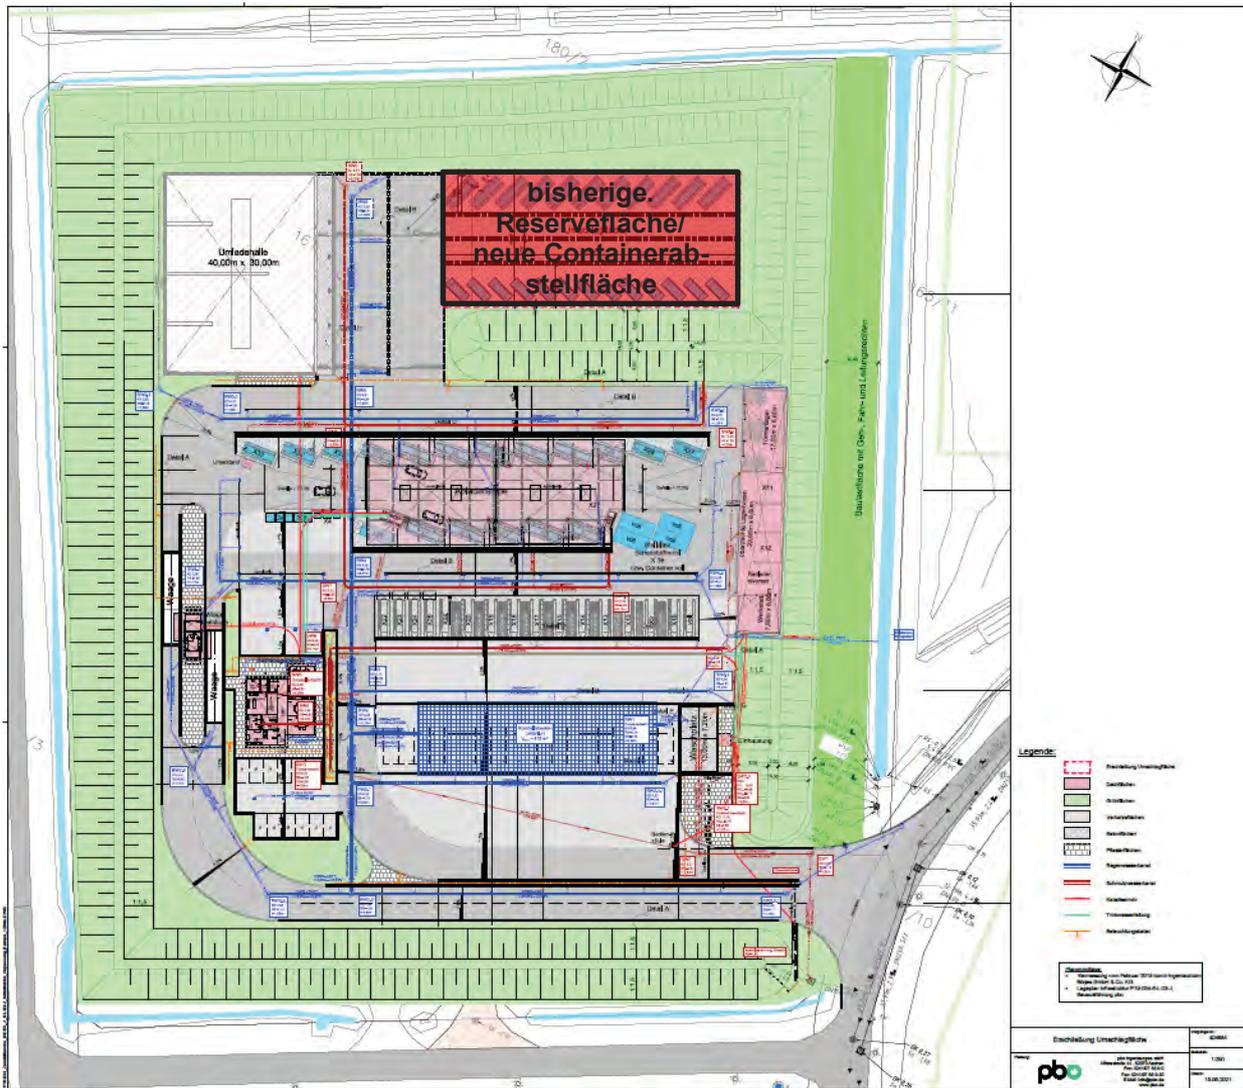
aktueller Betriebslageplan mit Darstellung in der zweiten Ausbaustufe
